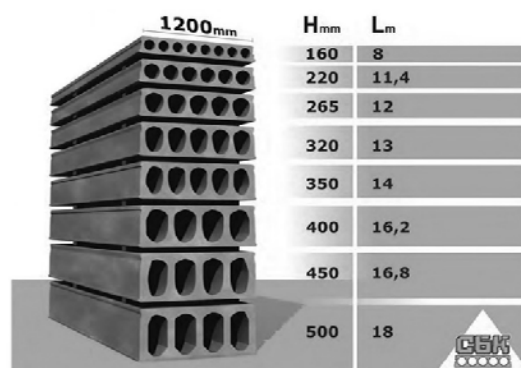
Сечения и максимальные длины многopустотных плит перекрытия
